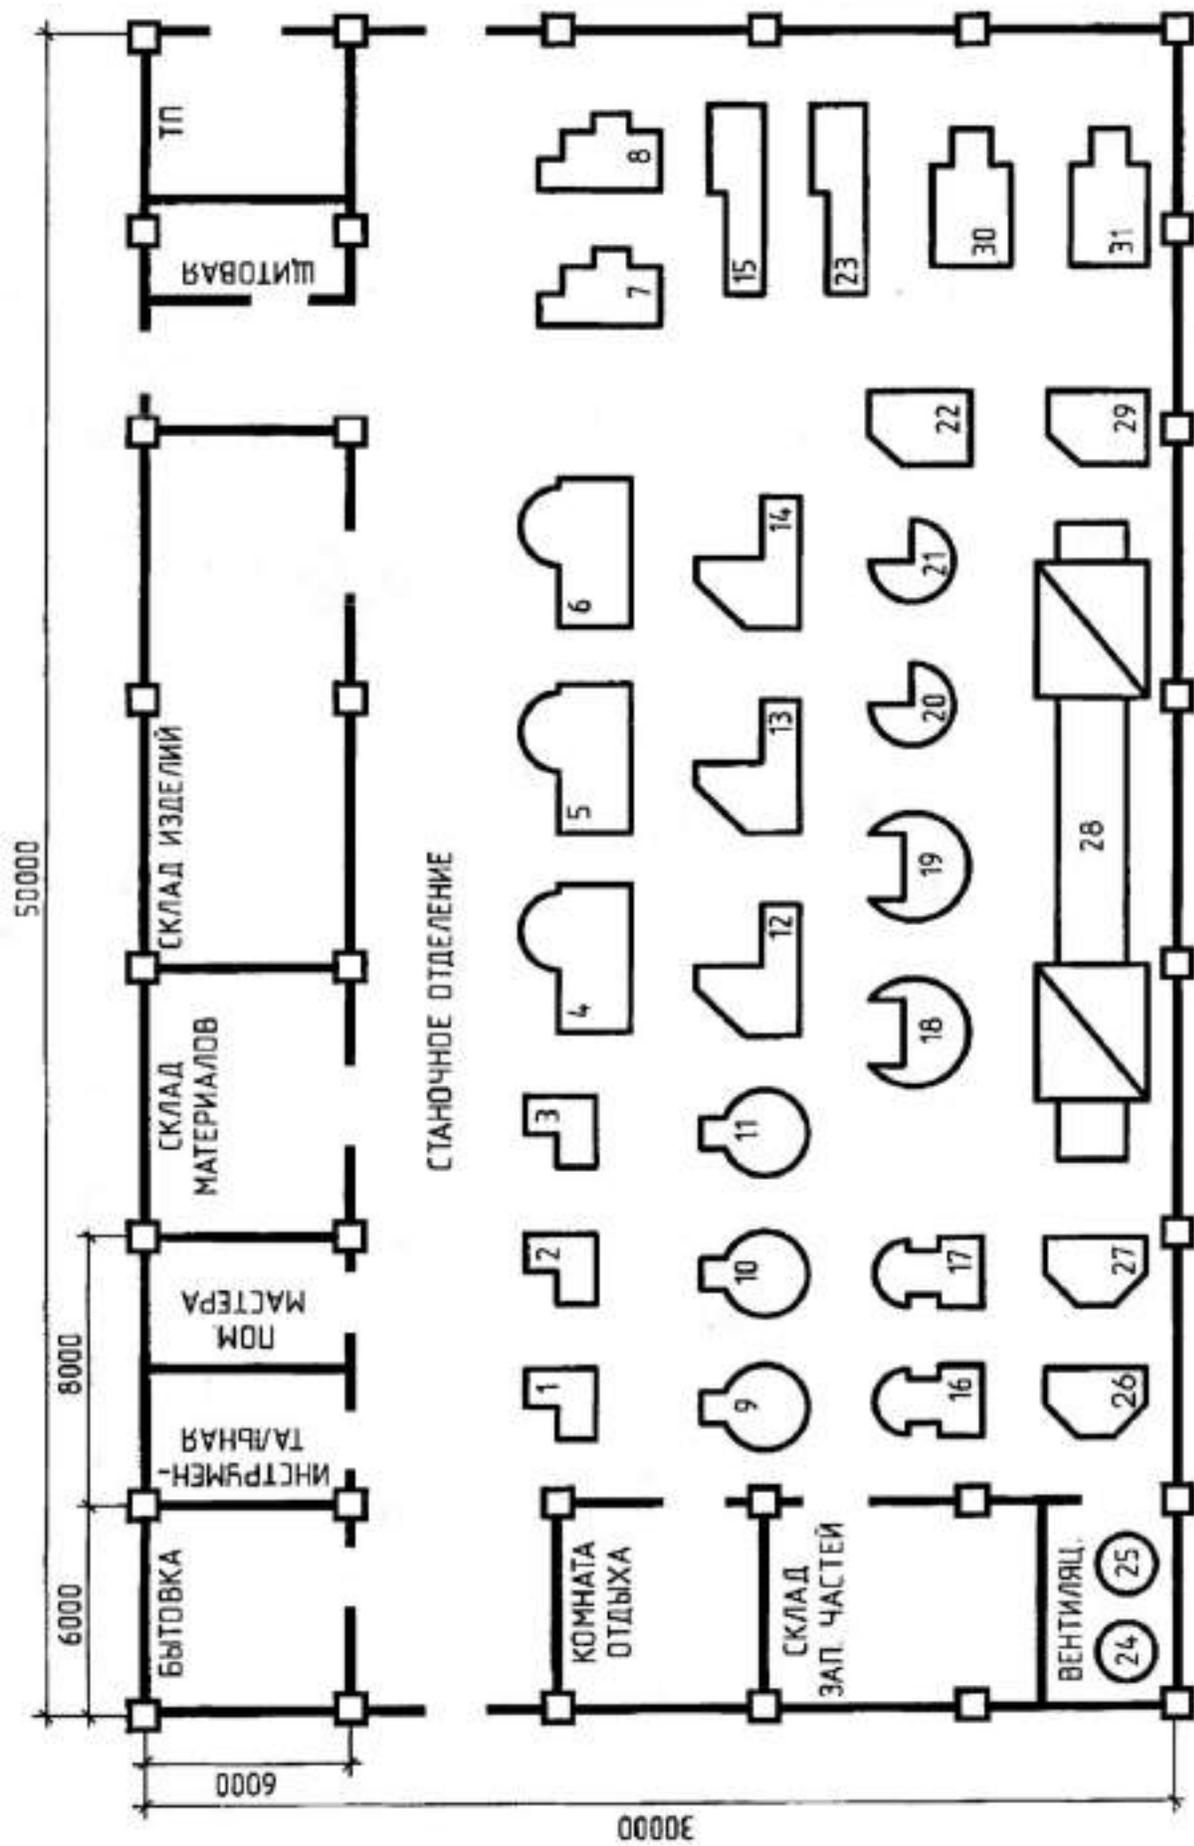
План расположения ЭО участка механосборочного цеха
